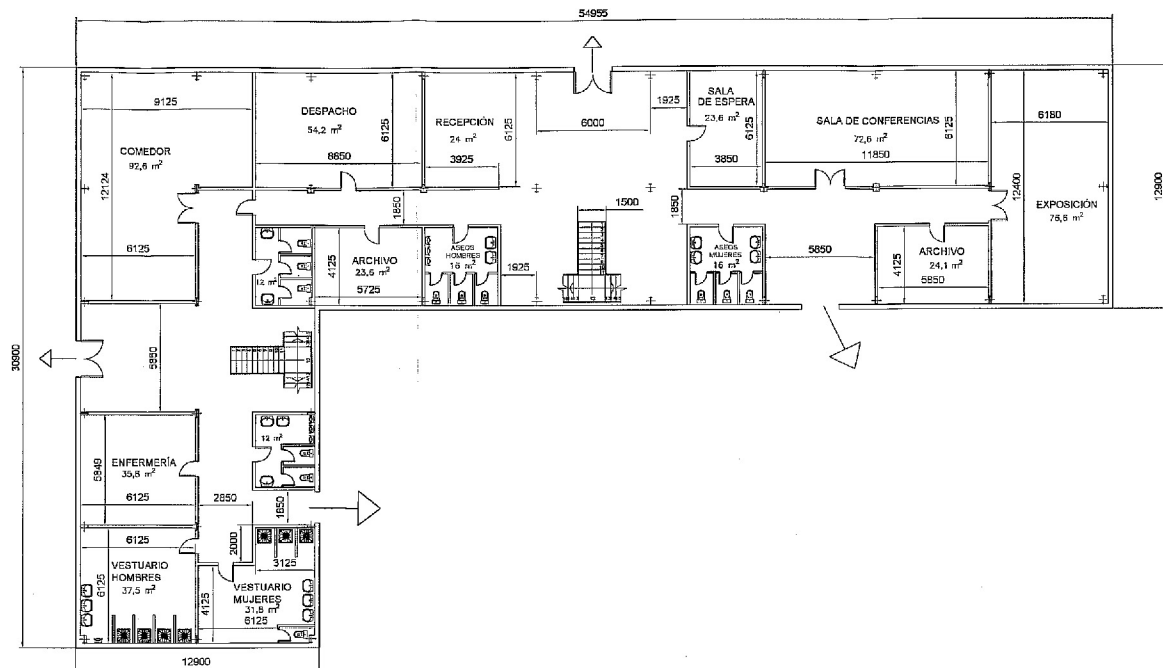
Cubierta y distribución en planta de un edificio de oficinas anejo a una nave industrial. (Fuente: A. Poy)
